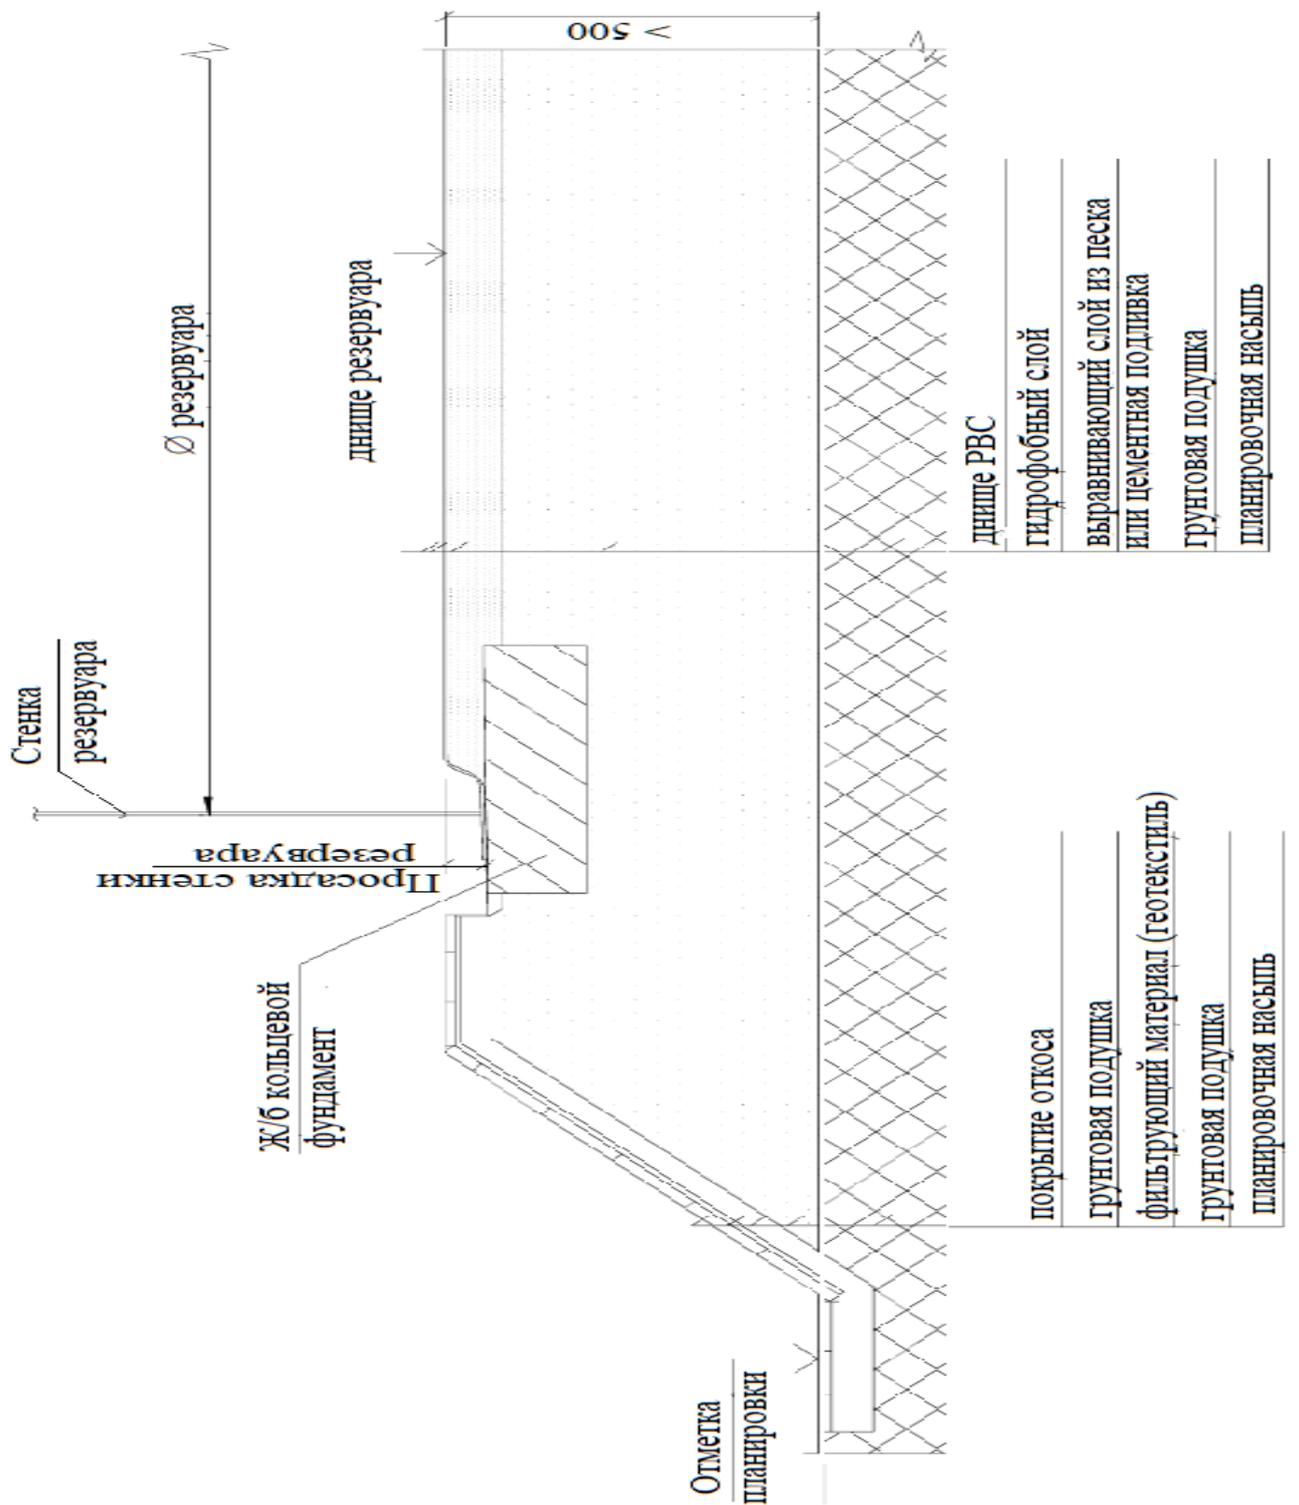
Просадка конструкции фундамента резервуар
